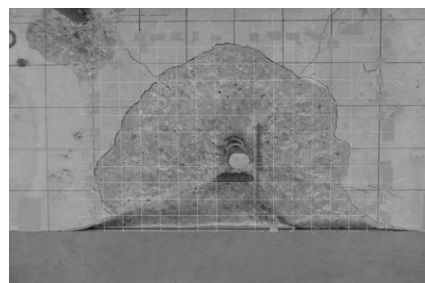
供試体上面の大規模なコーン状ひび割れ②を はつりとった状態 (Case-1)
